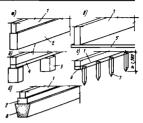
Конструктивные схемы фундаментов малоэтажных жилых зданий:
